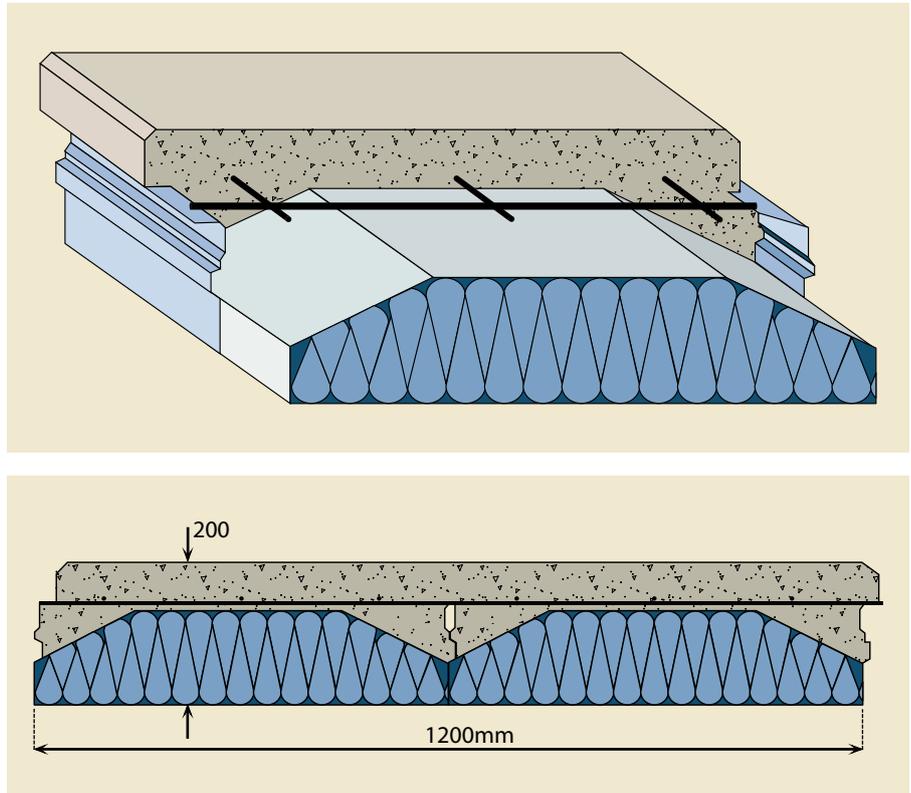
Vista isométrica y sección transversal del forjado Cofradal
